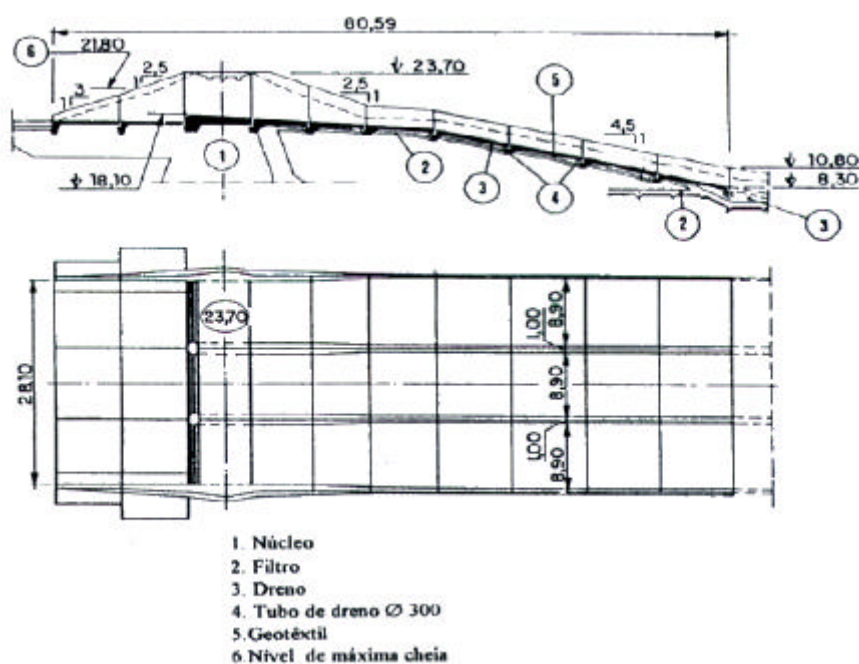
Barragem de Lebna, Tunísia. Perfil longitudinal e planta do descarregador (adaptado de ALBERT e GAUTIER, 1992).
